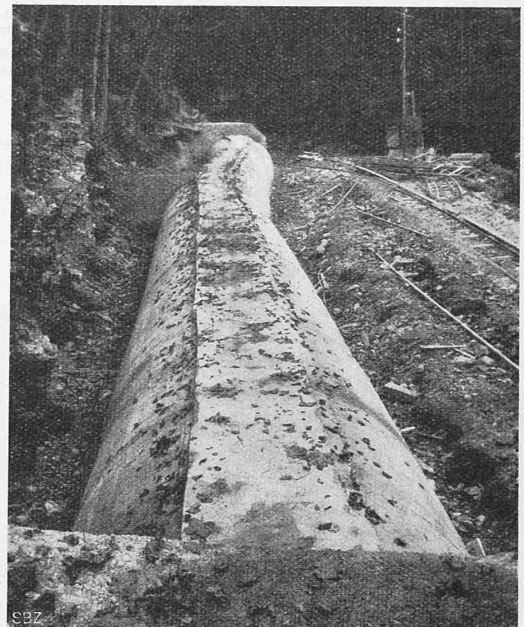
Das fertige Eisenbeton-Druckrohr, noch unüberdeckt.
